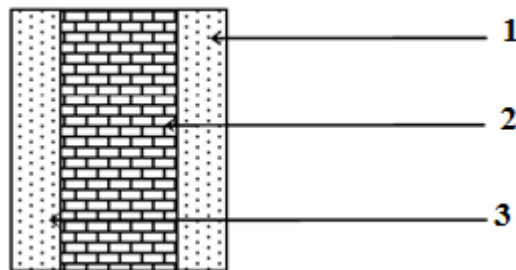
Coupe verticale d'un mur intérieur.
